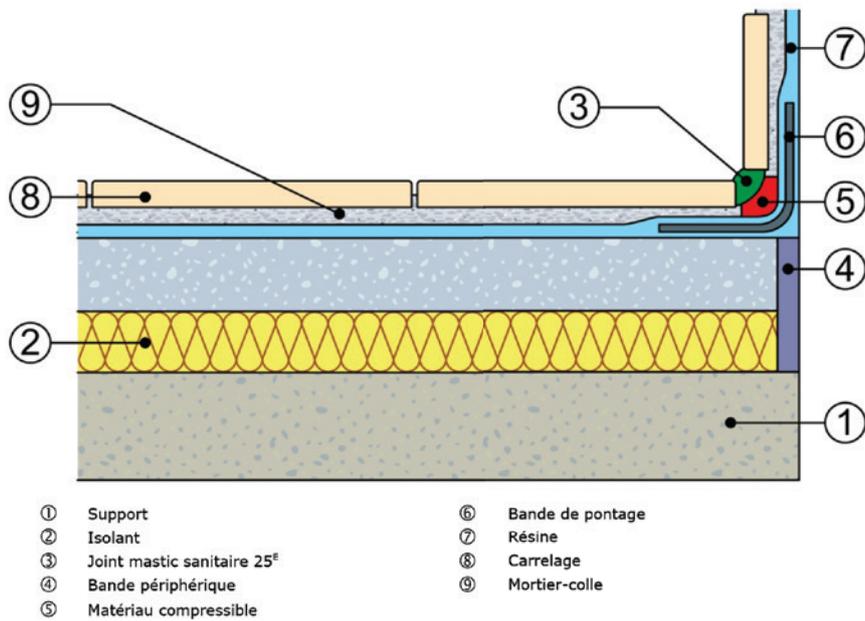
Traitement du raccord sol-mur sur chape flottante sur isolant acoustique mince ou plancher chauffant à eau
